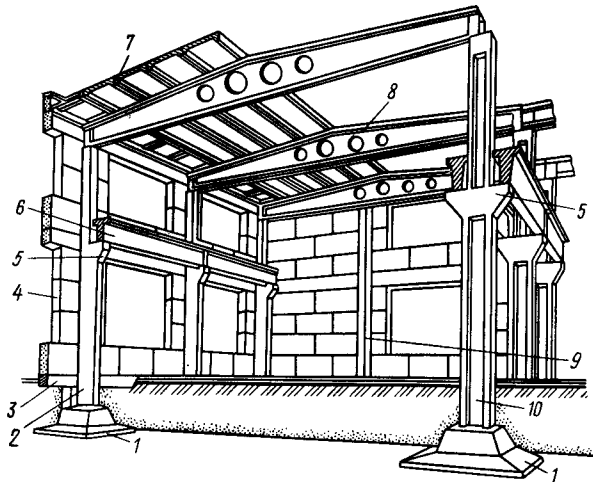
Фрагмент одноэтажного промышленного здания:
